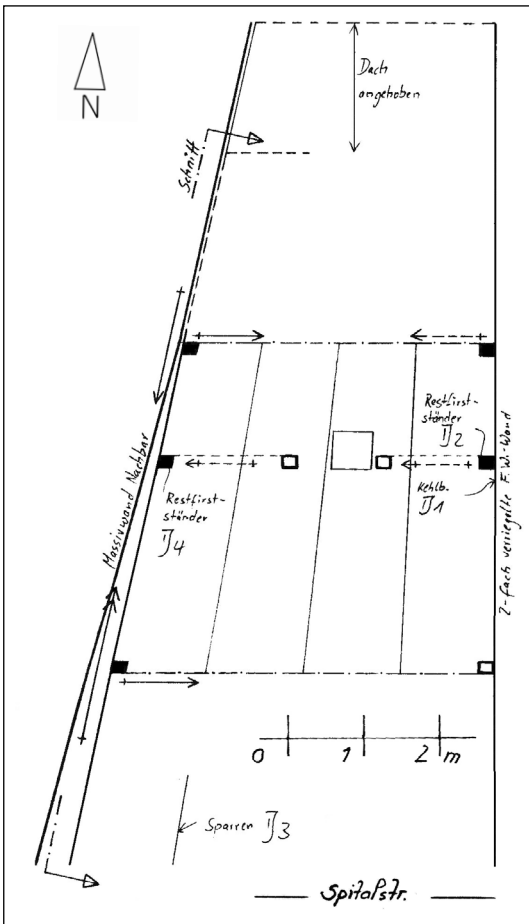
Spitalstraße 17, Grundriss 1. Dachgeschoss.
